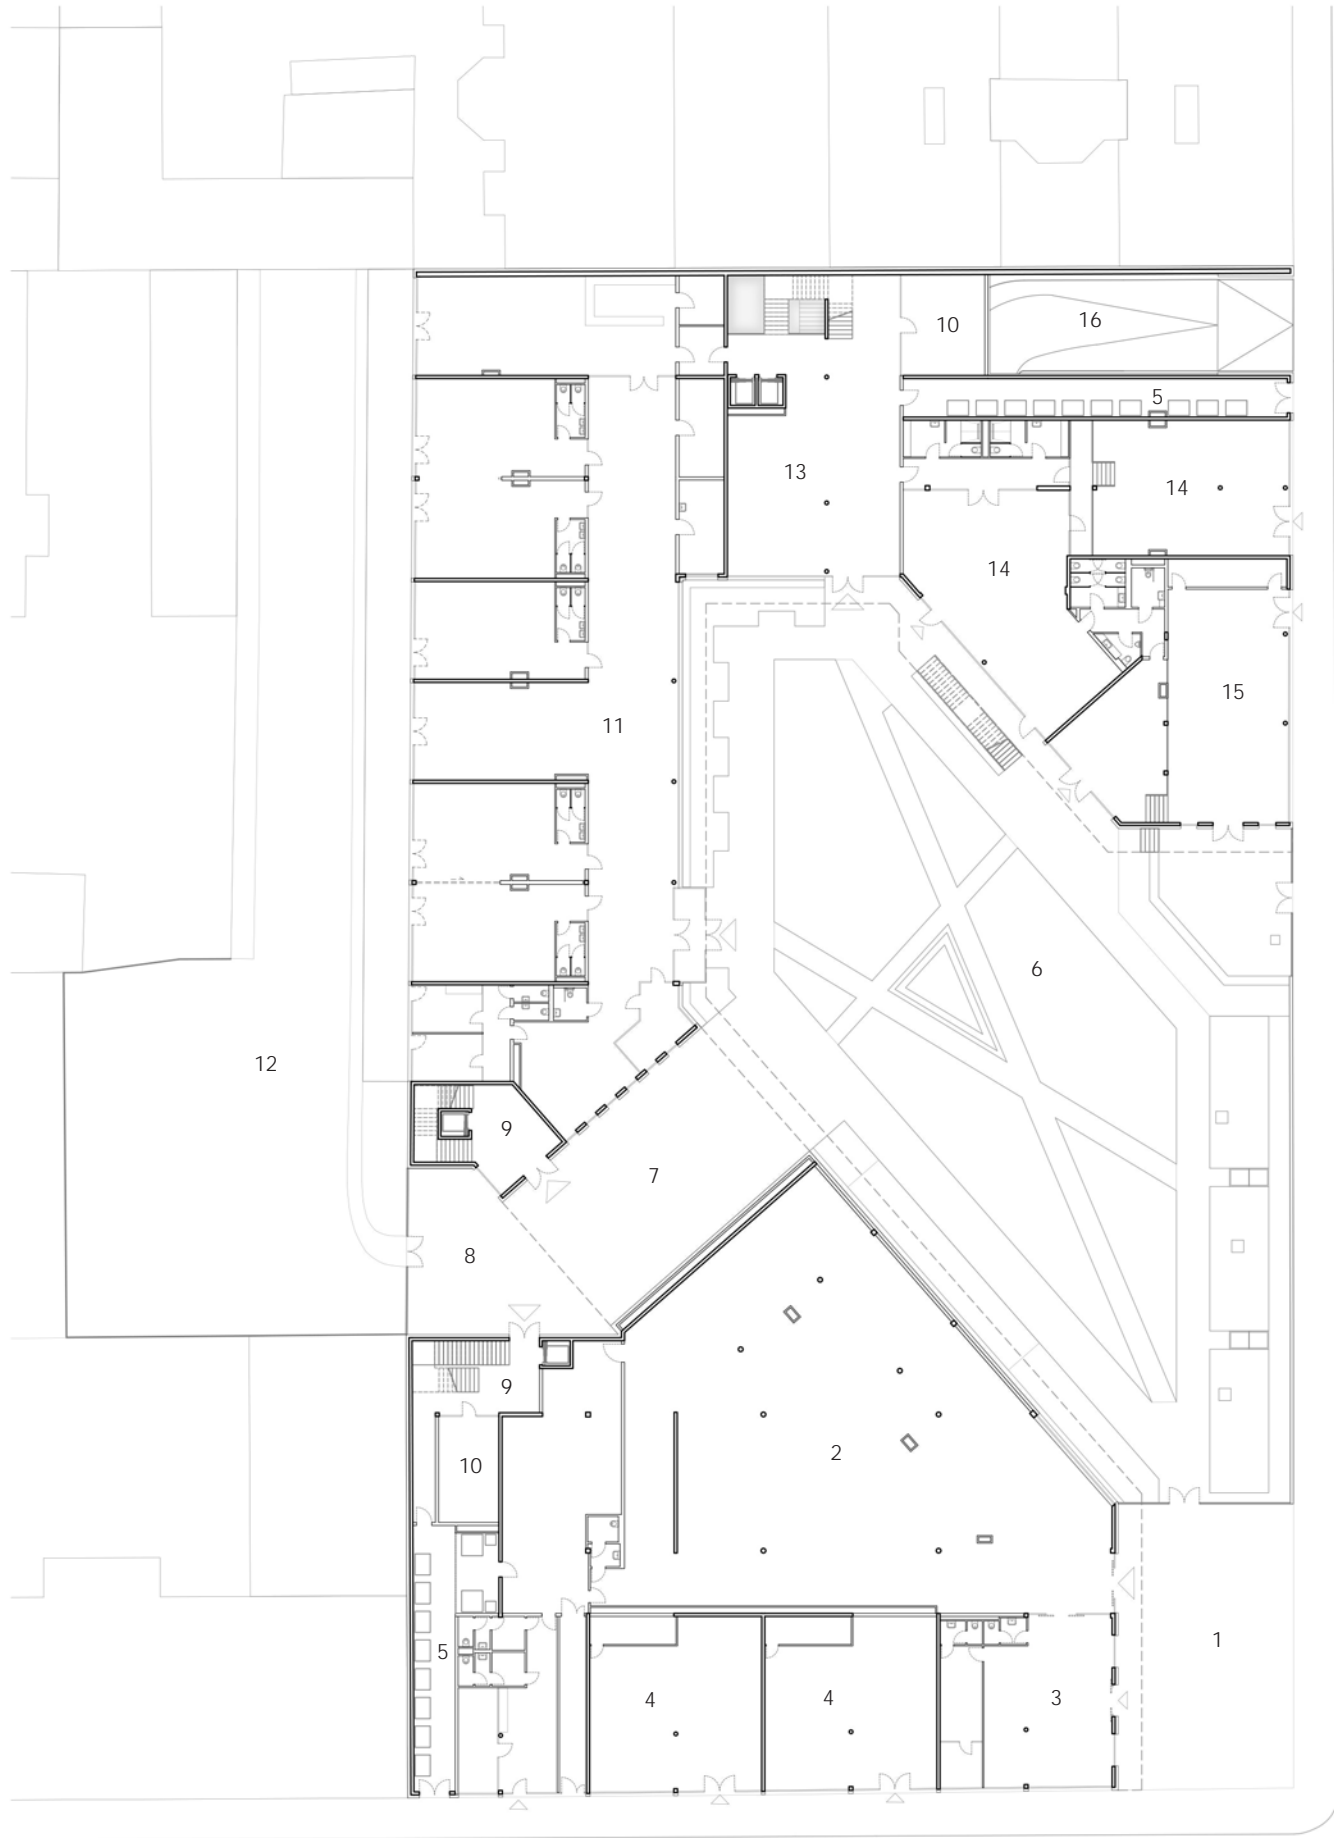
Grundriss Erdgeschoß - Lage der Stiegenhäuser.
